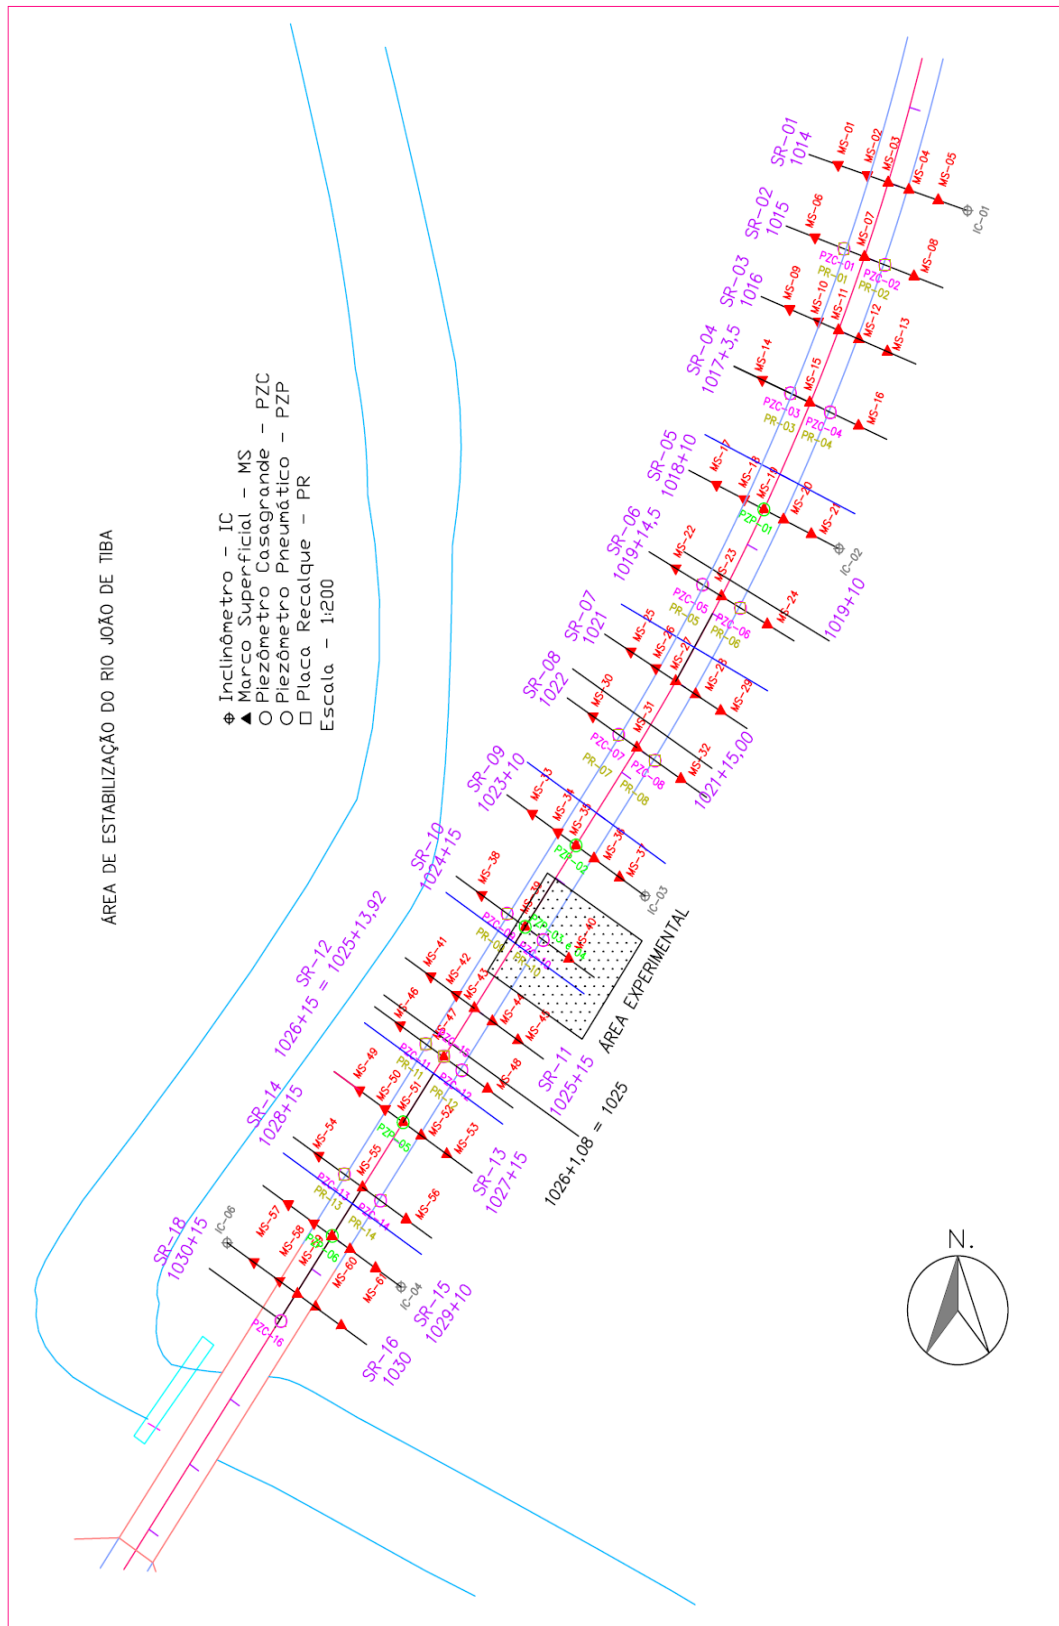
Projeto de instrumentação geotécnica na área de estabilização do rio João de Tiba (CAMPOS, 2004).
